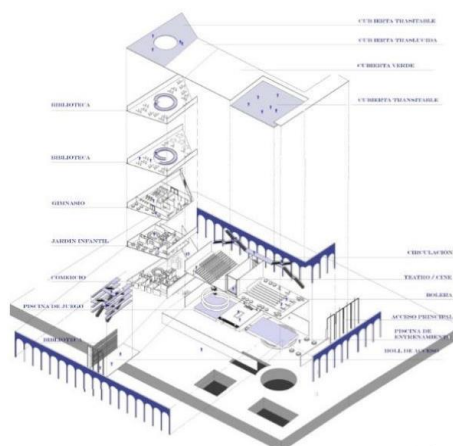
Propuesta Arquitectónica – Viviana Bautista.
